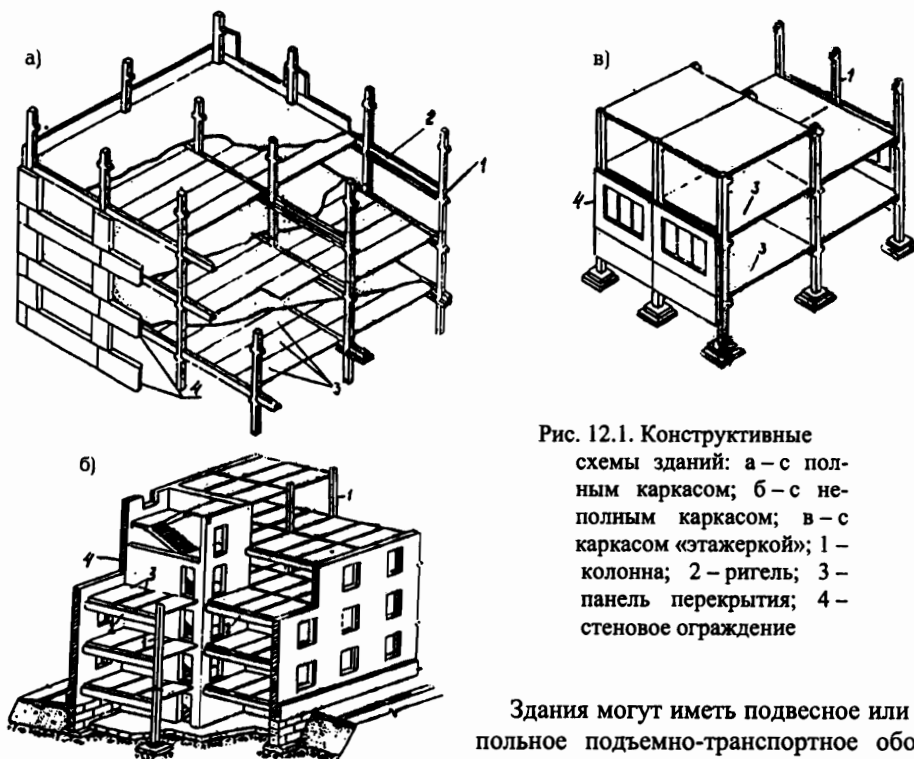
Конструктивные схемы зданий: а – с полным каркасом; б – с неполным каркасом; в – с каркасом «этажеркой»; 1 – колонна; 2 – ригель; 3 – панель перекрытия; 4 – стеновое ограждение
